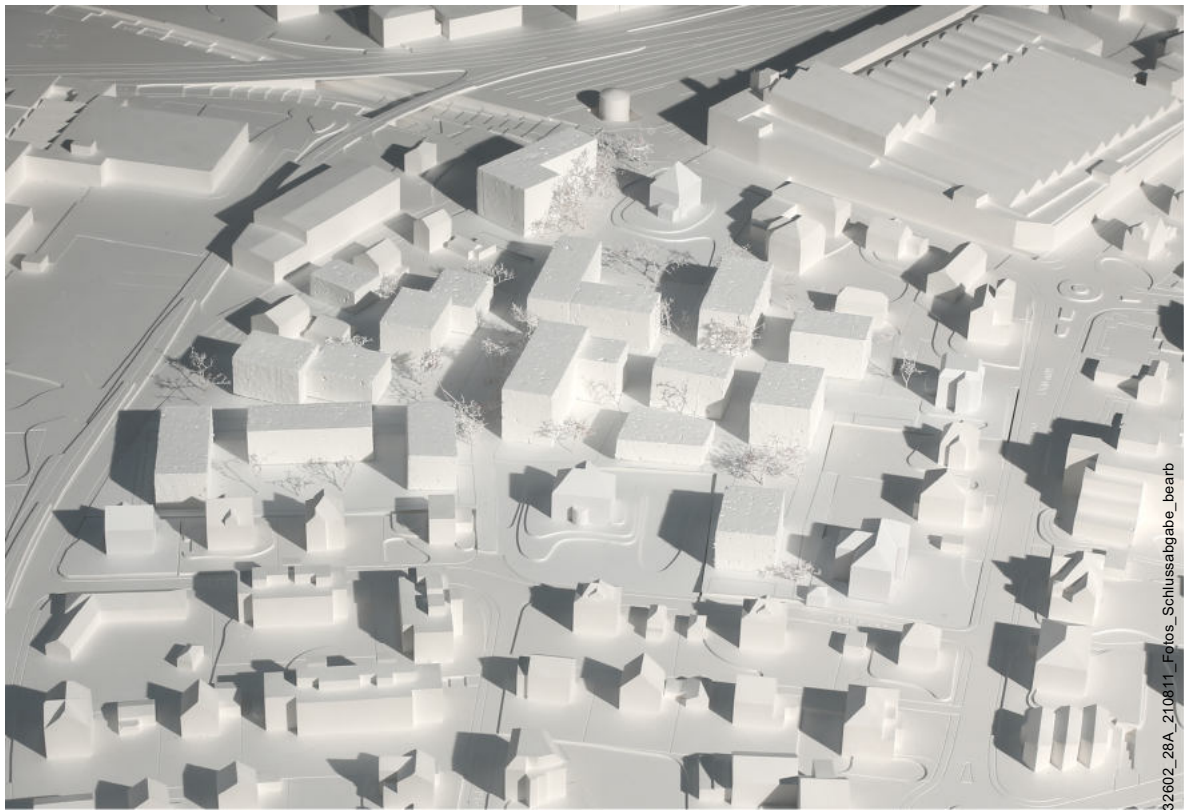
Modellfoto Süd-Ansicht, Team camponovo baumgartner architekten
